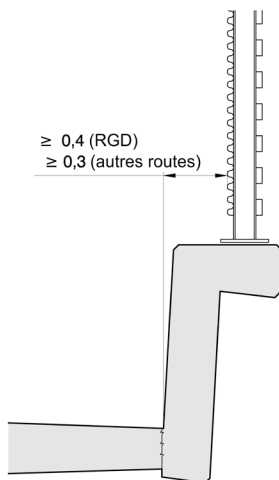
Paroi antibruit sur parapet système 92, GB 1150 droit avec inclinaison maximale de 6%, sur un pont et avec une distance minimale entre la face antérieure du parapet et la paroi antibruit
